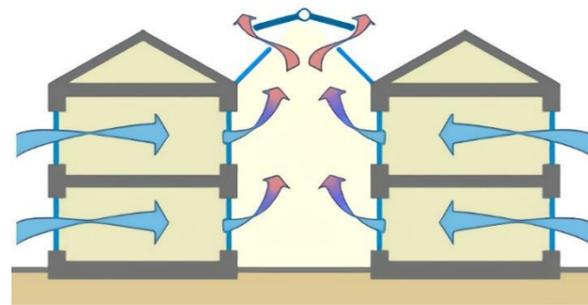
Schéma explicatif de la ventilation par la façade double peau
